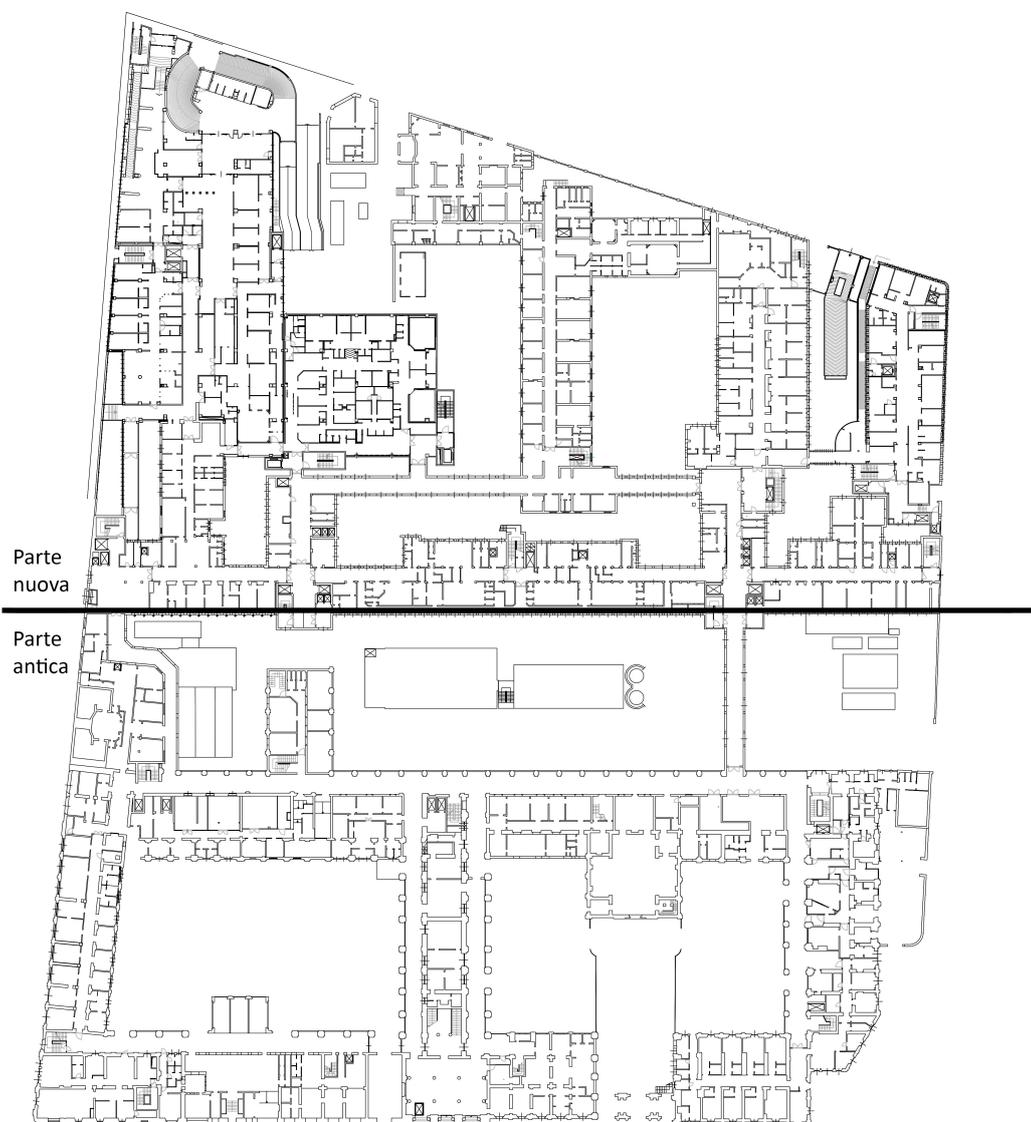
Pianta del piano terreno dell'Ospedale di Alessandria nel 2020
